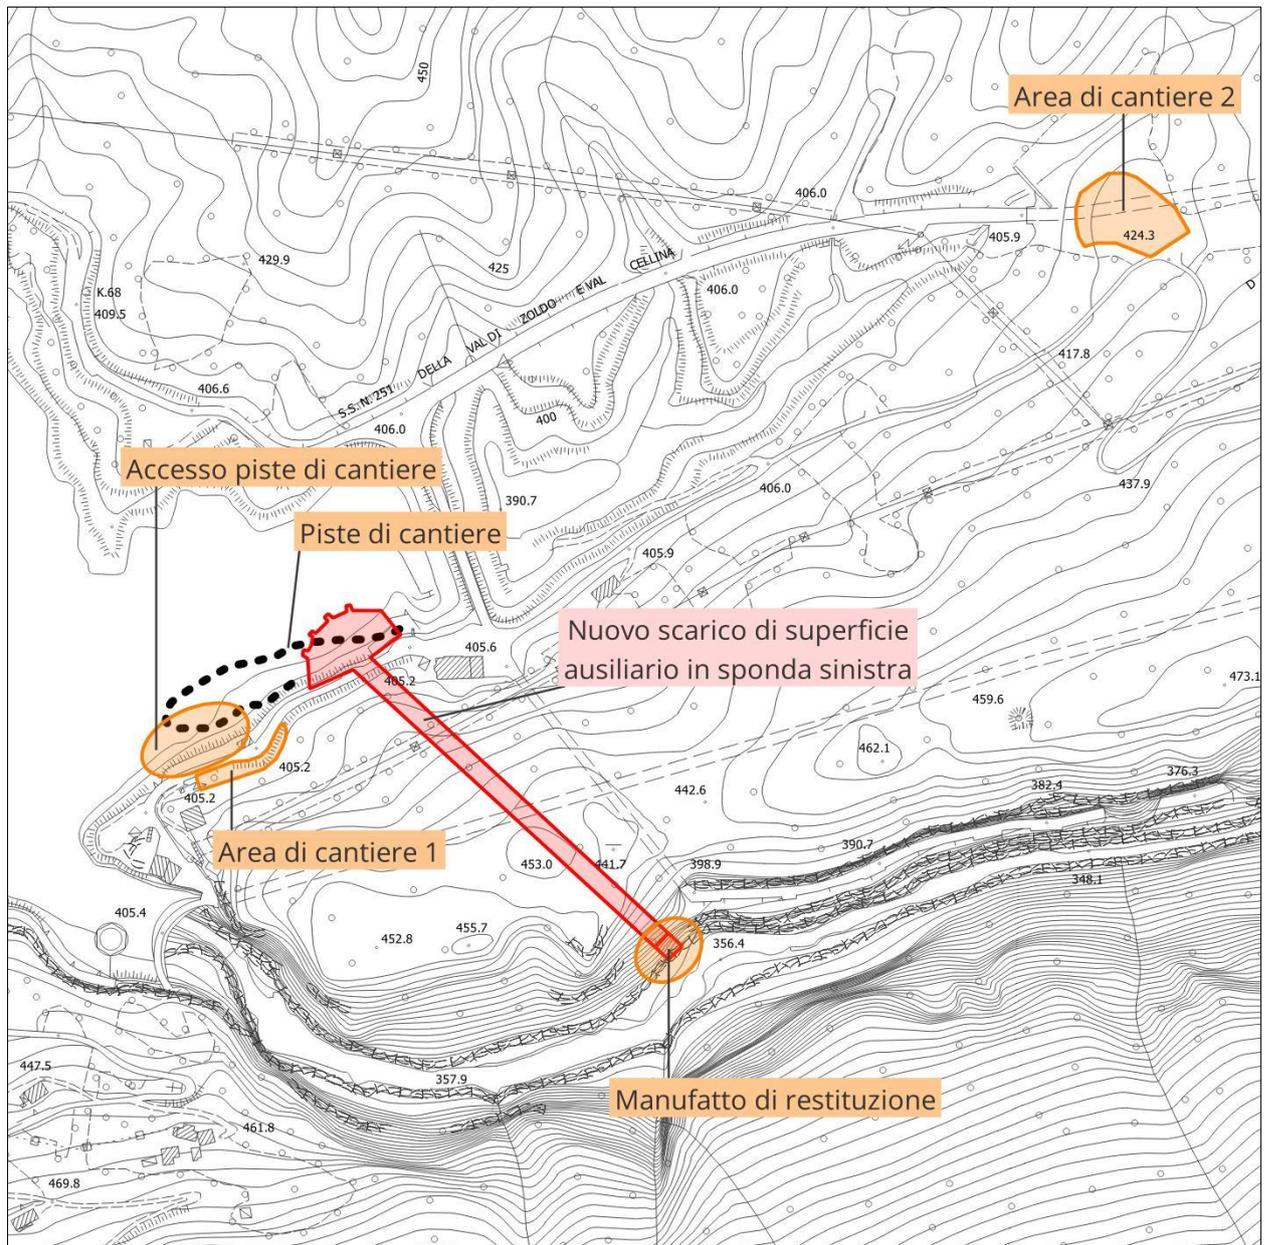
Localizzazione generale delle aree e piste di cantiere.
